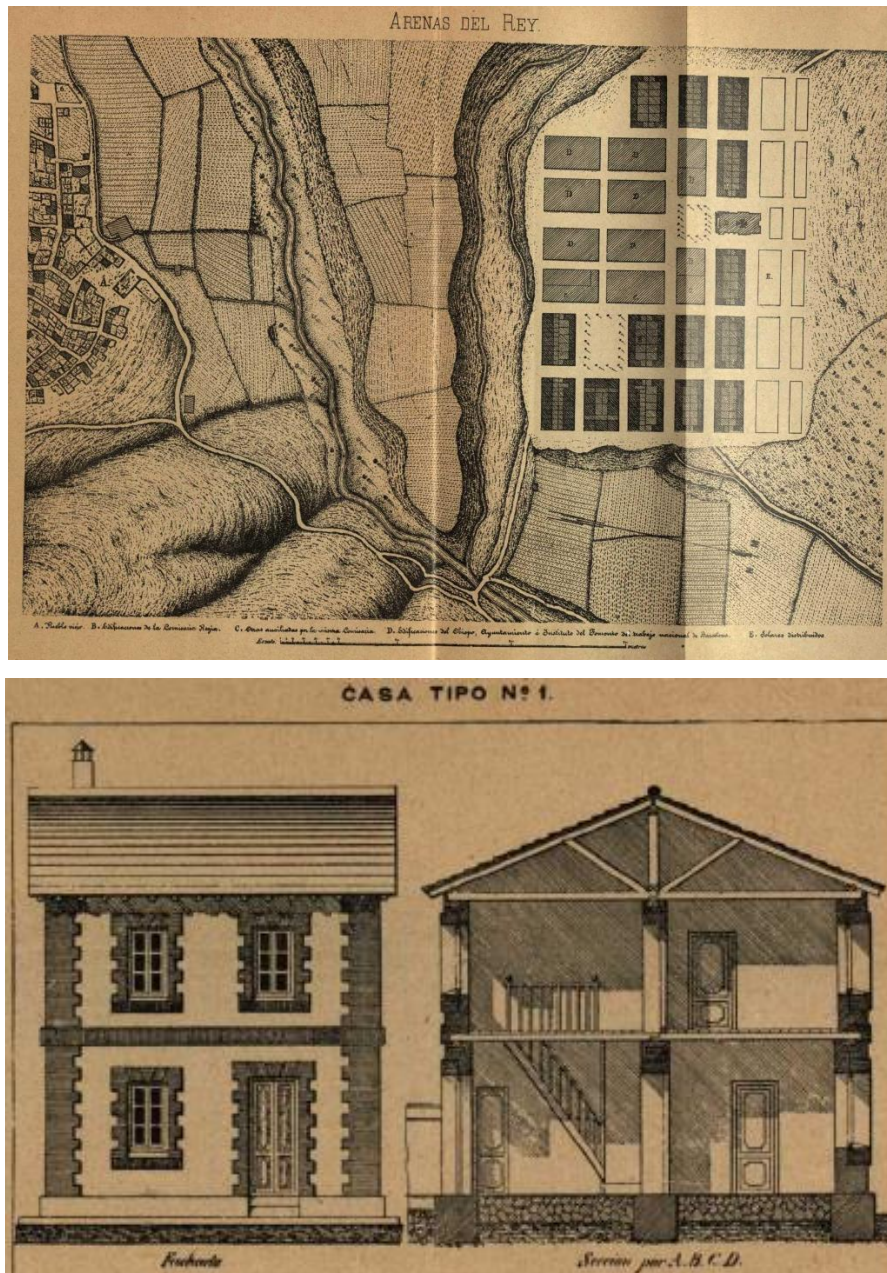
Arriba: plano de la nueva planta de Arenas del Rey, a 500 m del antiguo. Abajo: Plano de las nuevas viviendas construidas. Fuente: Memoria del Comisario Regio (Lasala y Collado, 1887).
